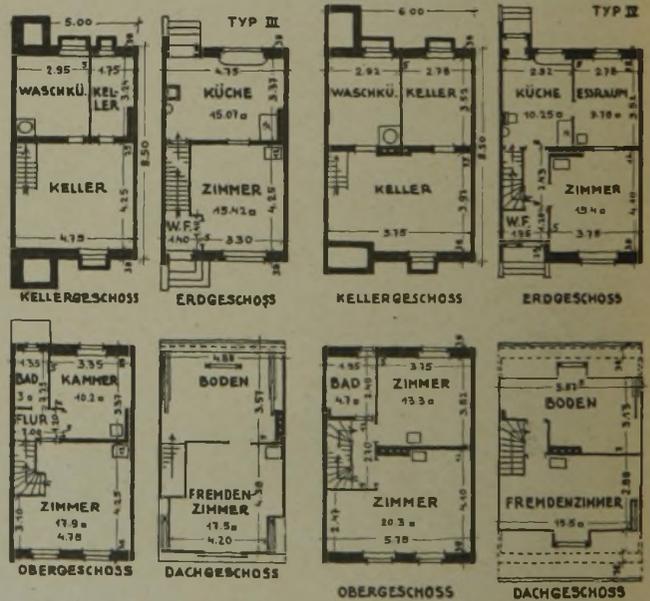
Grundrisse des Keller-, Erd-, Ober- und Dachgeschosses eines Einfamilienhauses mit 3 Zimmer und Kammer.
